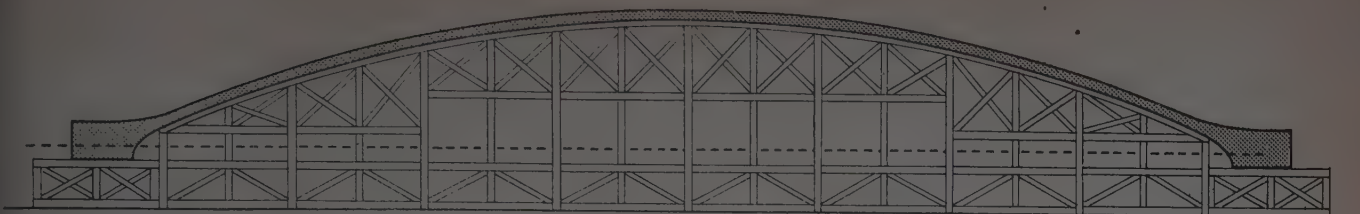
Poutre. Construction de l'arc sur échafaudage; la culasse étant en place avec le tirant libre.
